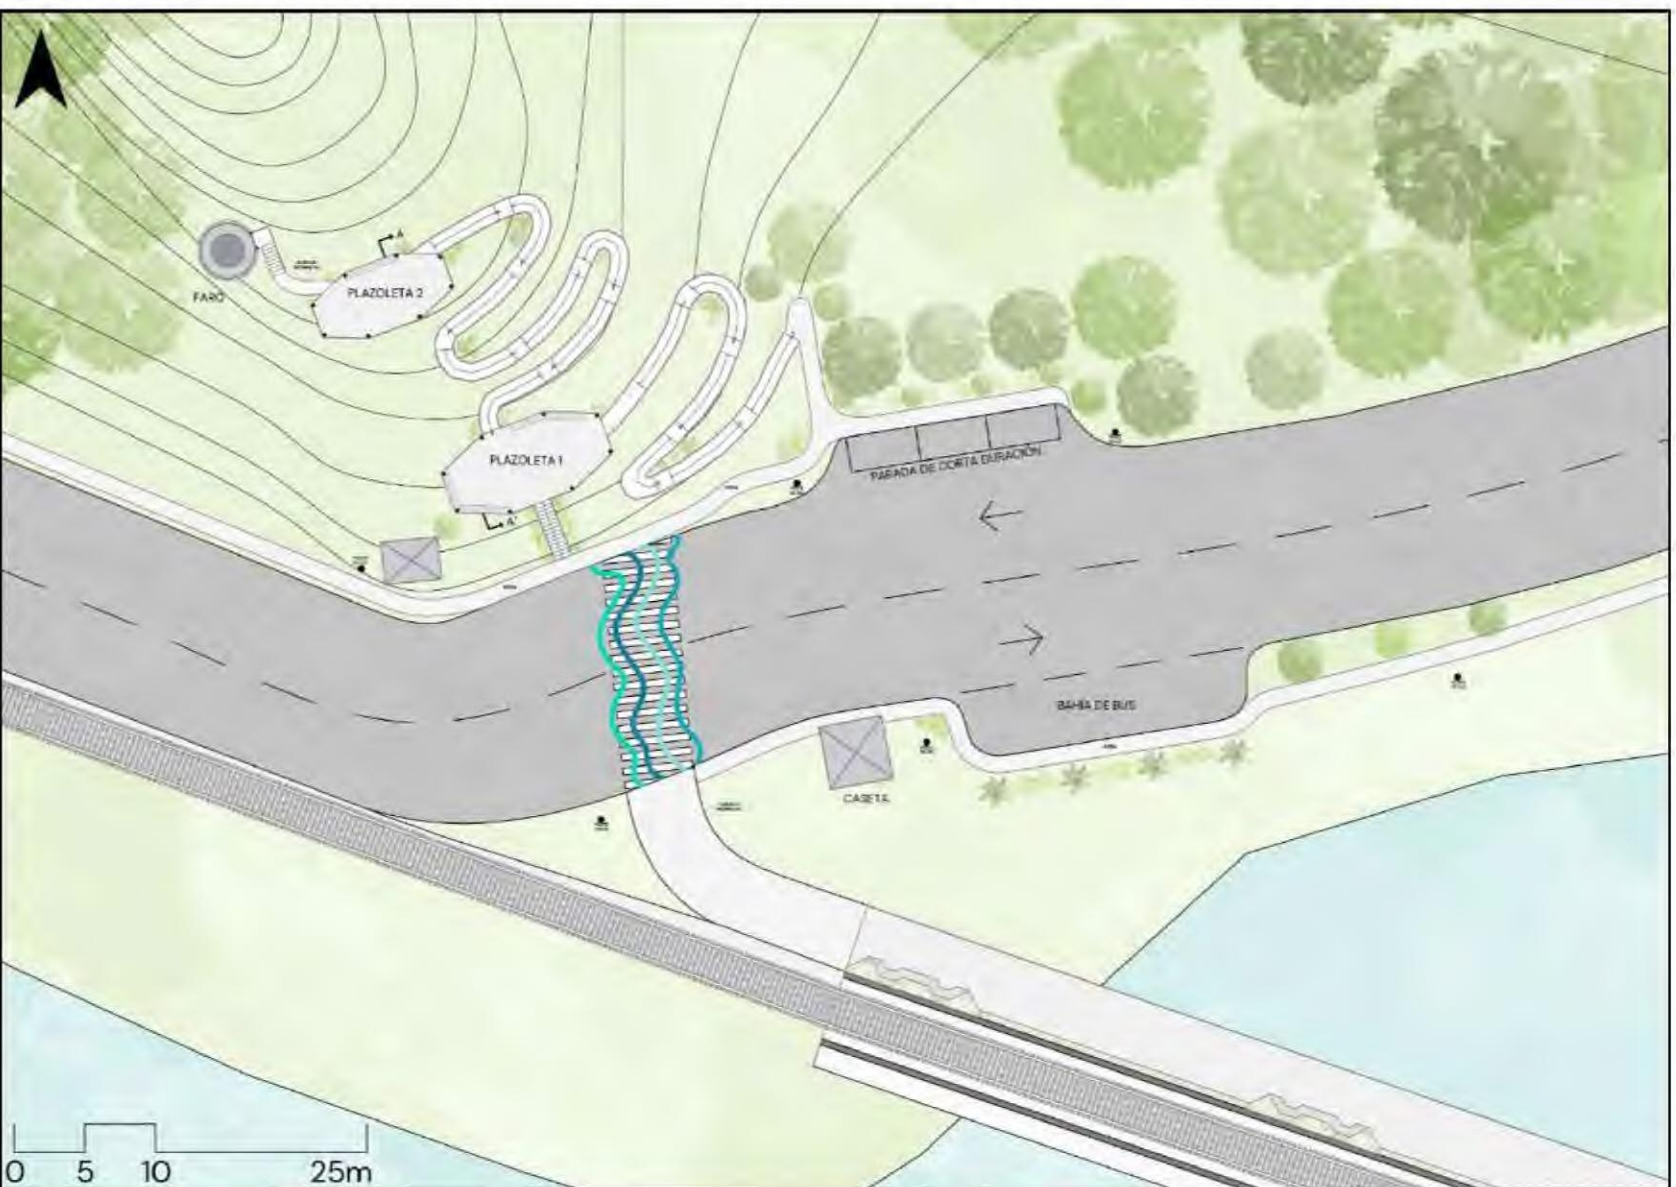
Planta arquitectónica del mirador "El Faro". Fuente: Autoría propia.
